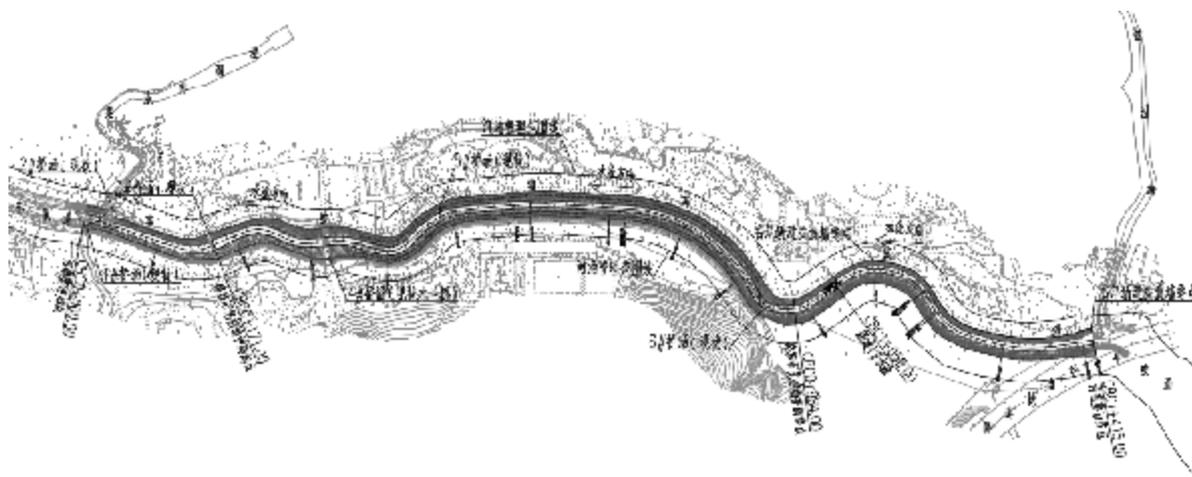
车陂涌（华南国家植物园段）总平面图
